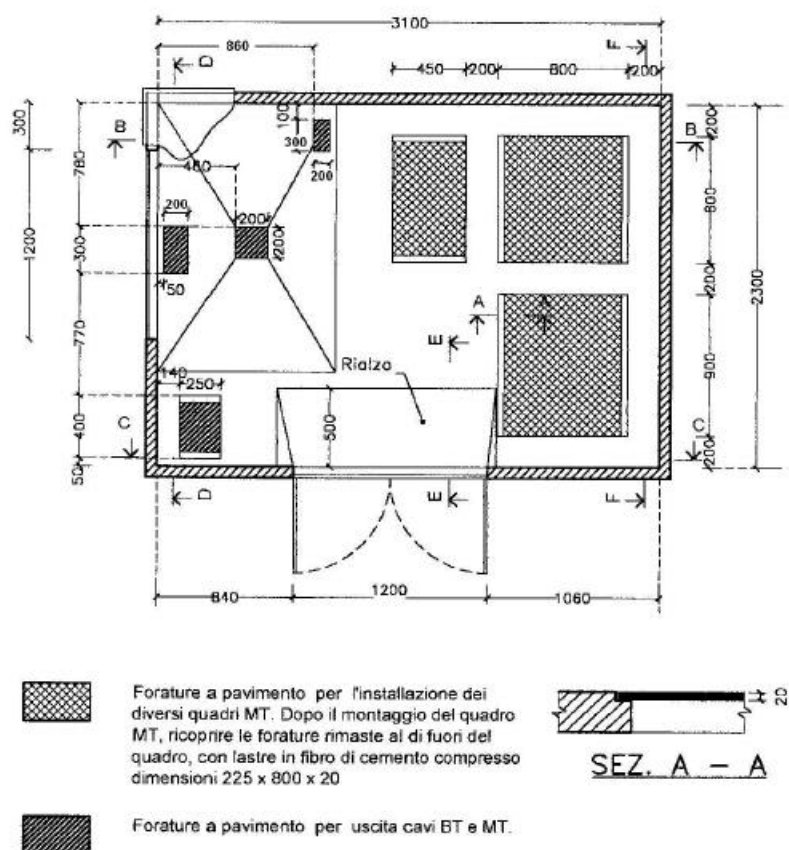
Layout cabina E-Distribuzione – pianta
